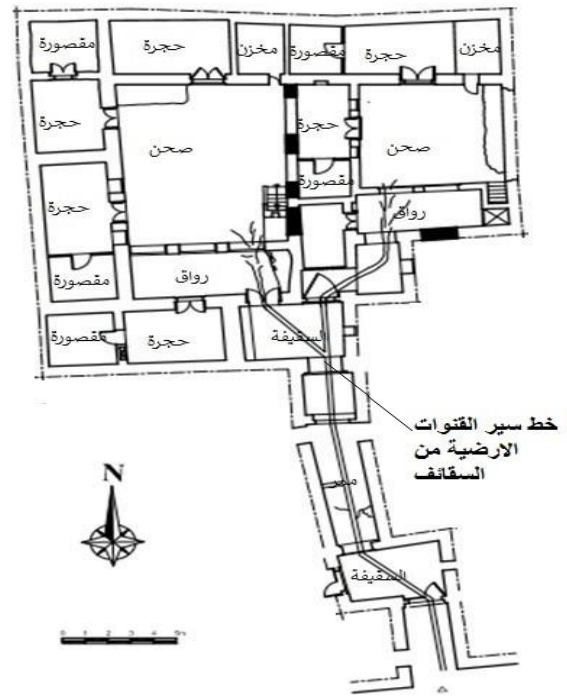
مسقط أفقى للطابق العلوي لمنزل الوادى
